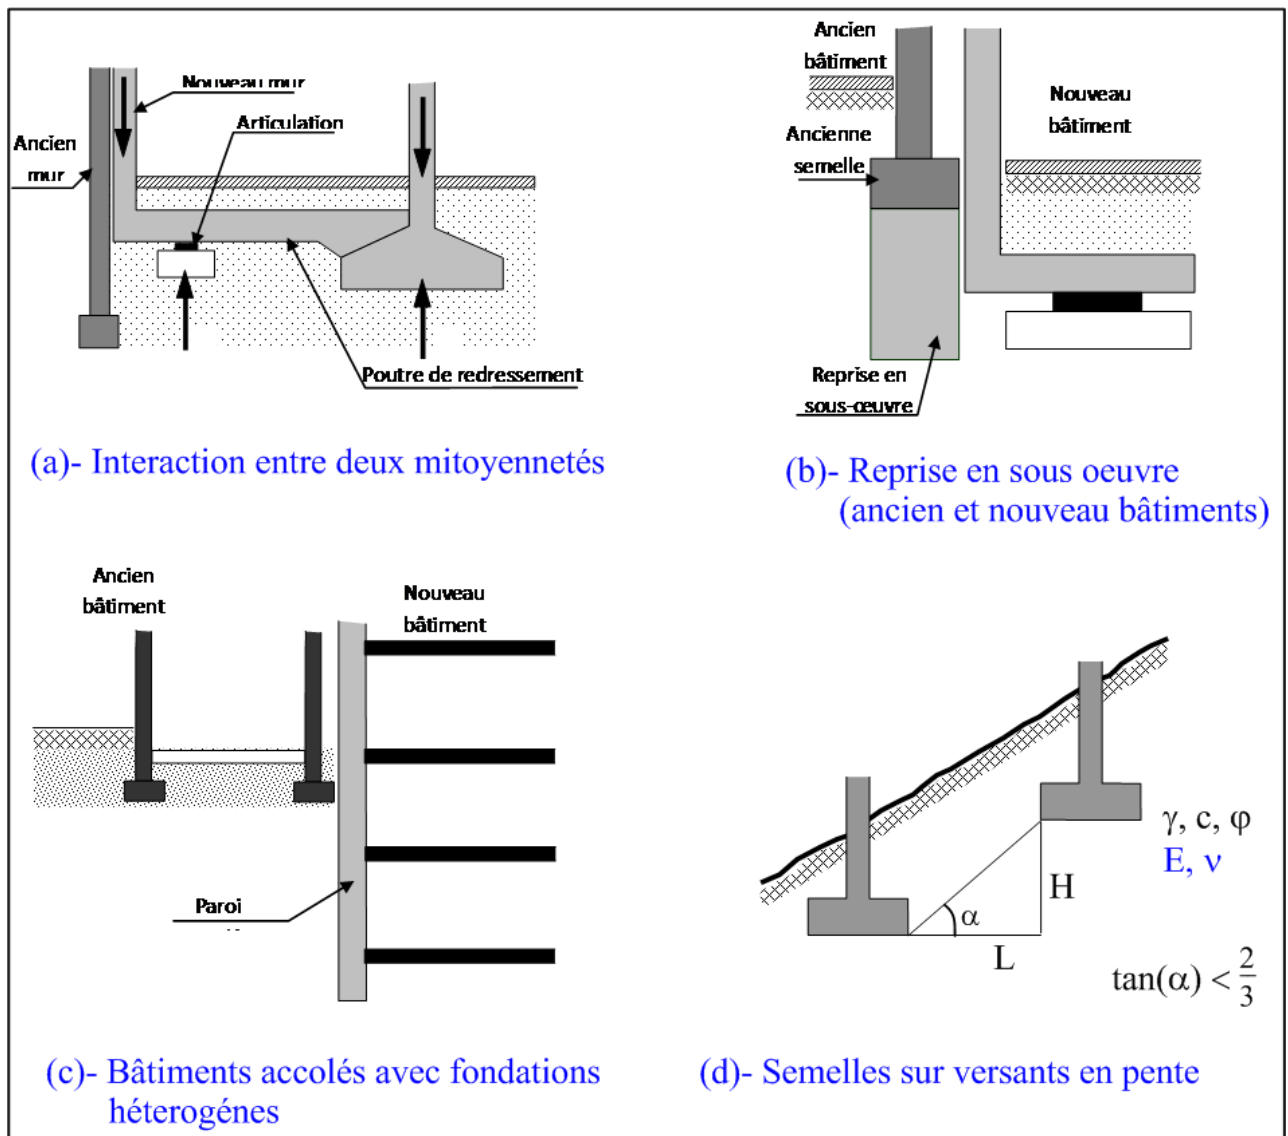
Quelques dispositions constructives sur les fondations superficielles.
